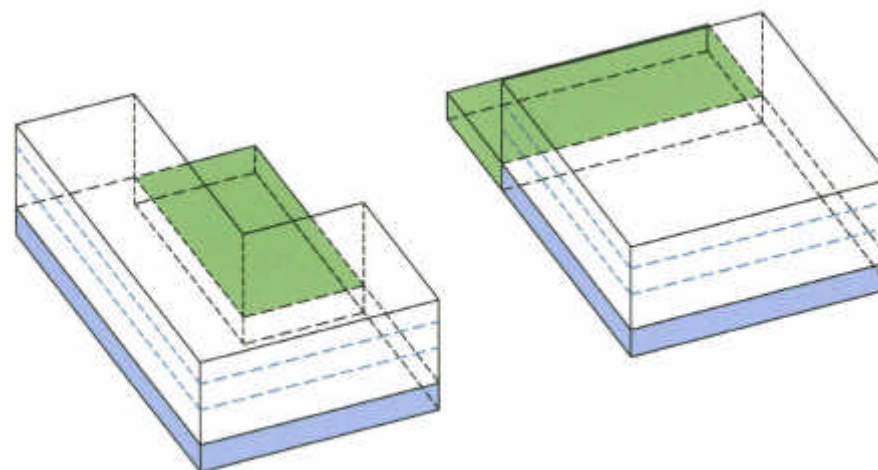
ESQUEMAS DEL ÁREA LIBRE Y CONSTRUIDA DE LOS TIPOS. Lo que permite alojar un aparcamiento subterráneo, así como usos compatibles con la residencia en planta baja.
